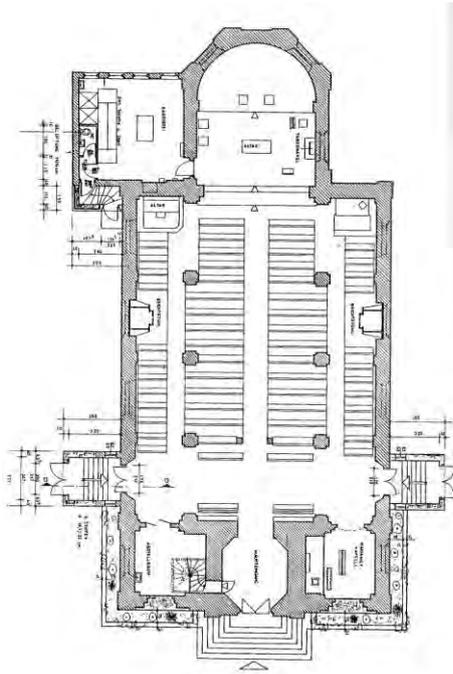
Grundriss der Pfarrkirche aus dem Jahr 1985
